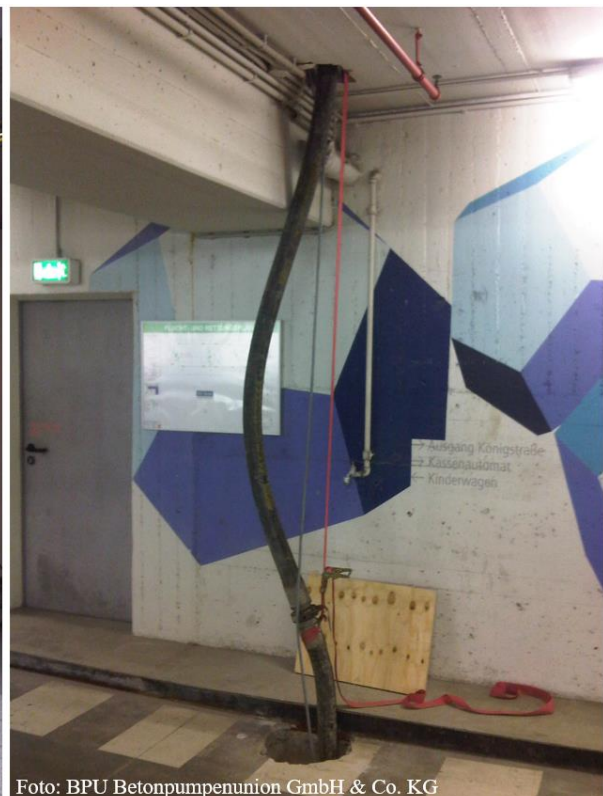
Förderschlauchführung beim Bauen im Bestand: Betonage in einer Tiefgarage.
